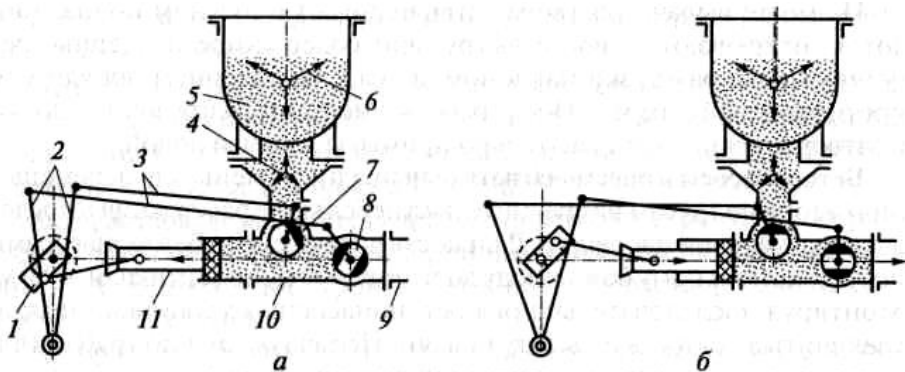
Горизонтальный поршневой бетононасос с механическим приводом: а — всасывание; б — нагнетание
